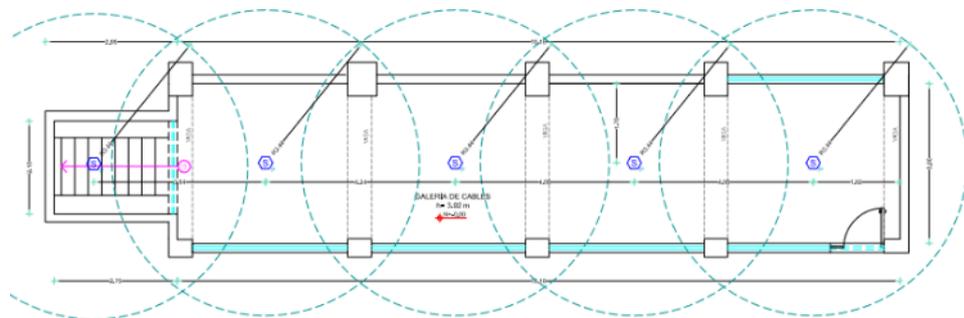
Plano de cobertura de sensores de sala de Galería de Cables
